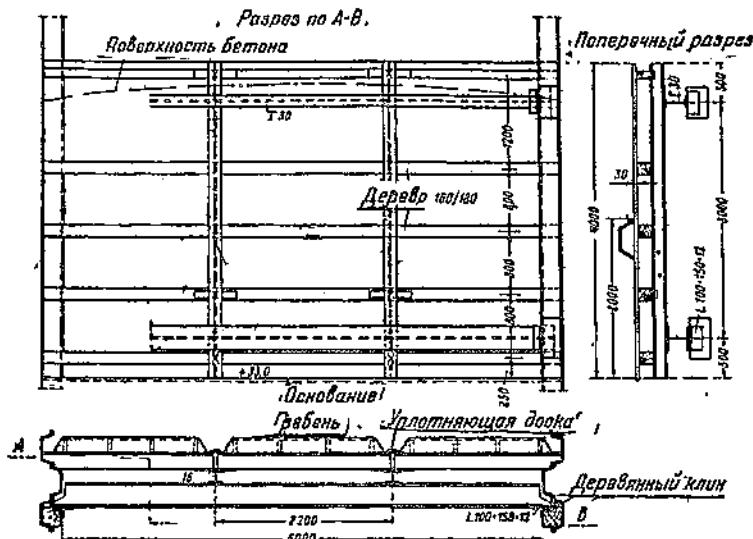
Опалубка фундаментной плиты мола, состоящая из 3 щитов.
